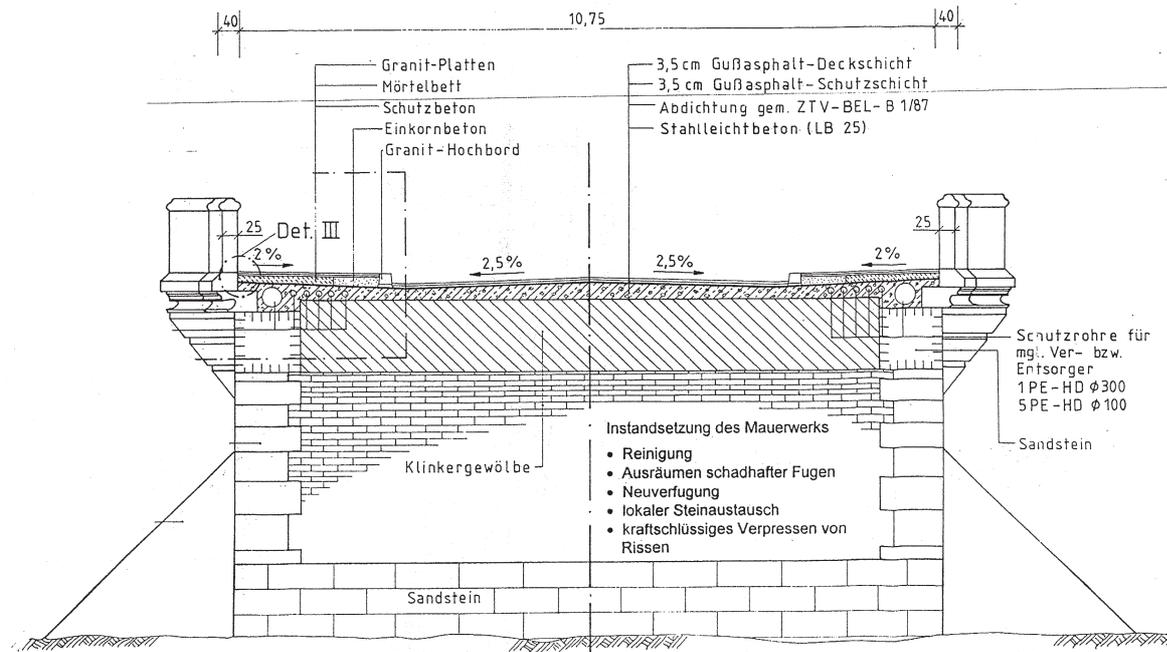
Saalebrücke Bad Kösen - Schnitt durch den Scheitelbereich
